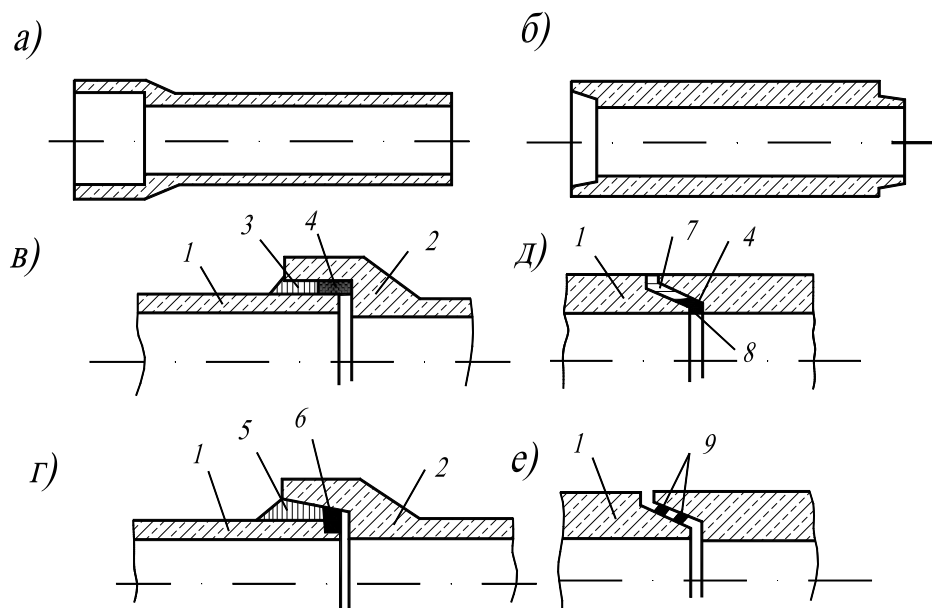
Бетонні і залізобетонні труби і способи їх з'єднання:
